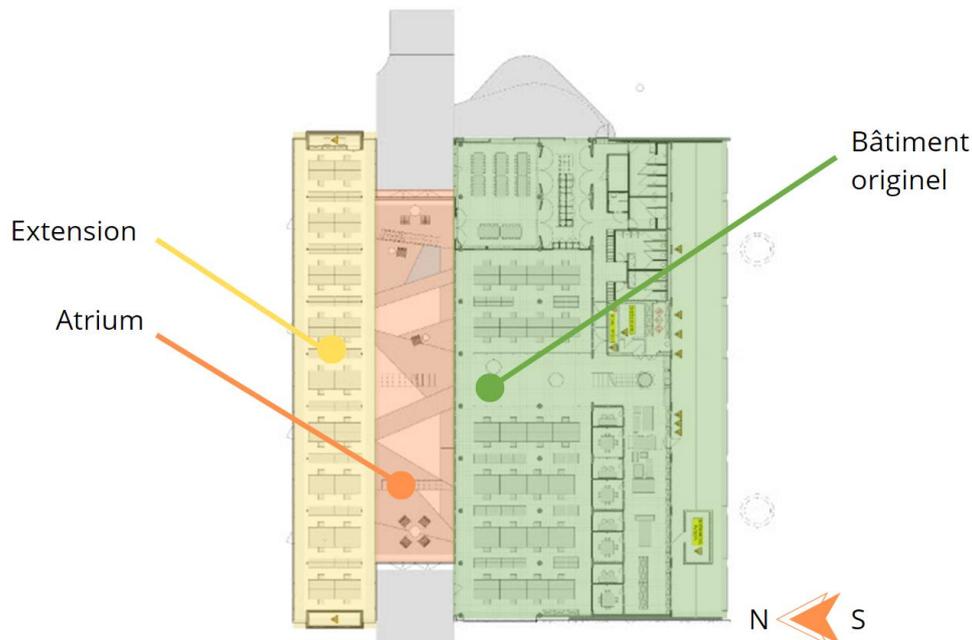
Plan du sous-sol des zones du bâtiment étudié
